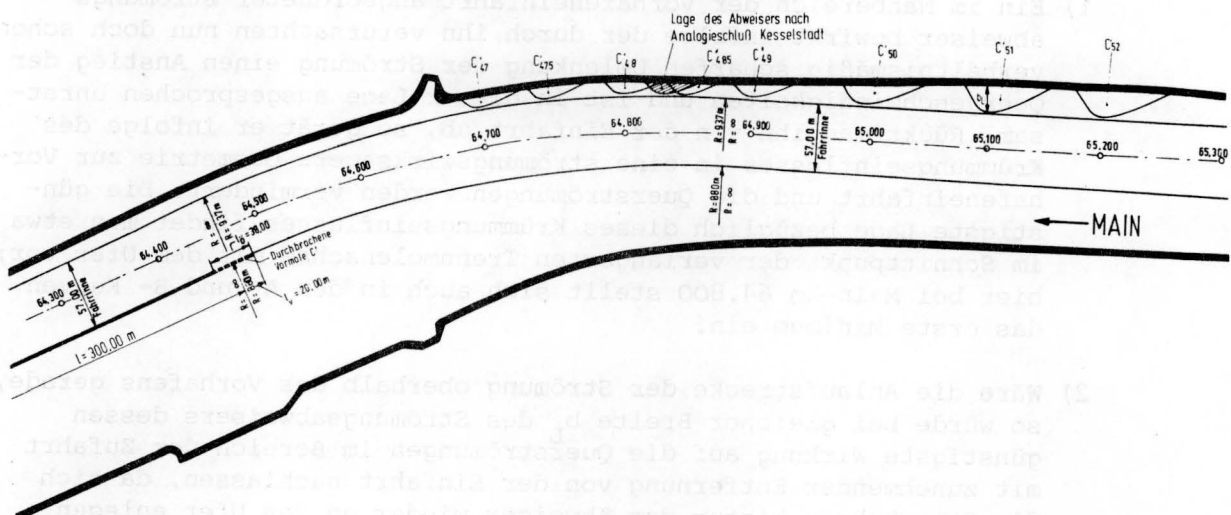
Untersuchte Lagen des Strömungsabweisers; Lageplan
